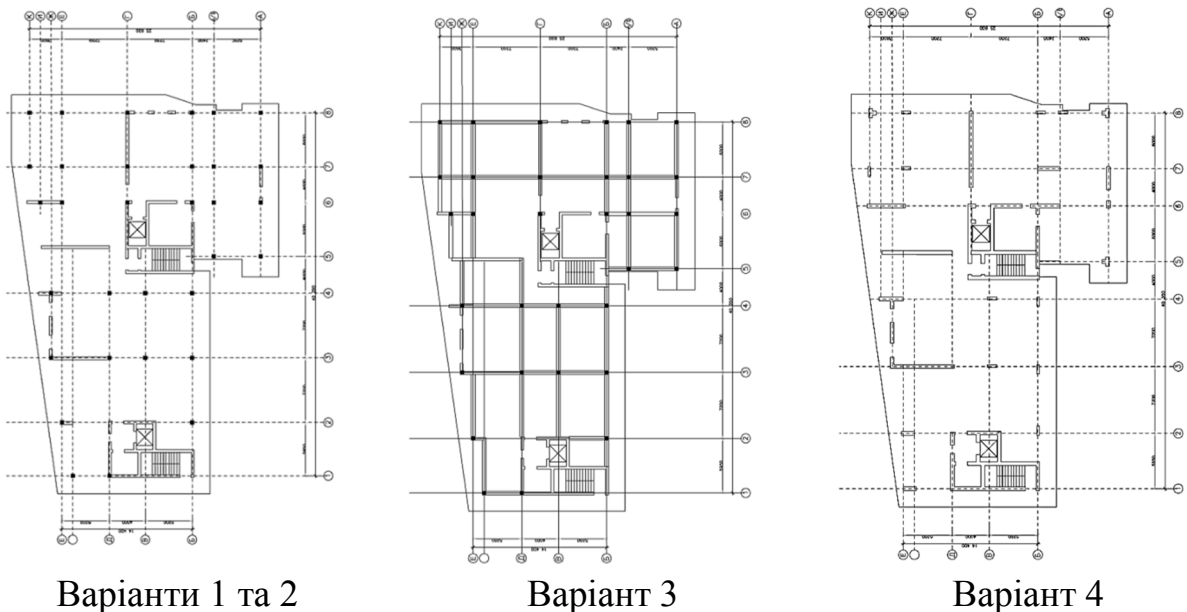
Схеми перекриття типового поверху для варіантів конструктивних схем
